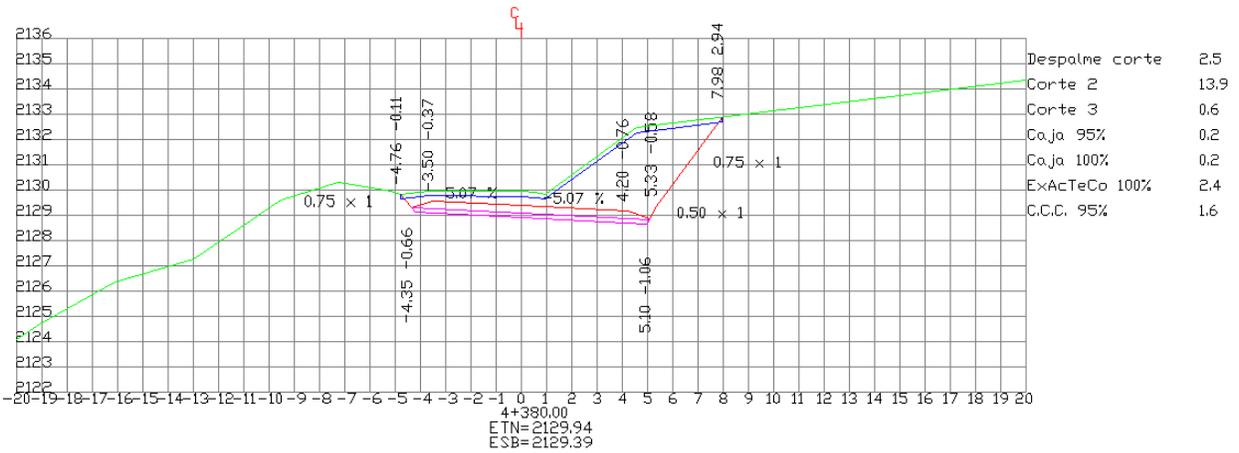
Sección transversal, km 4+380, en zona donde se requiere defensa metálica lado izquierdo.
